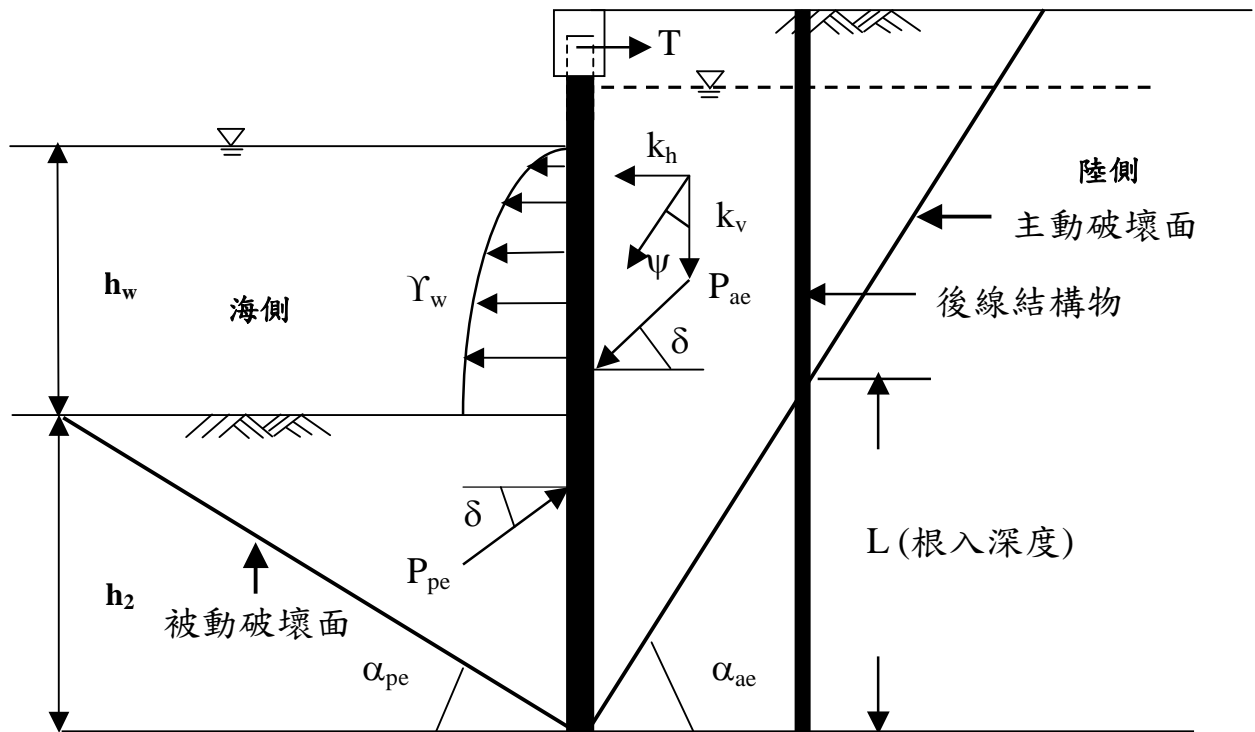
板樁式碼頭後線結構物穿越主動破壞面示意圖
